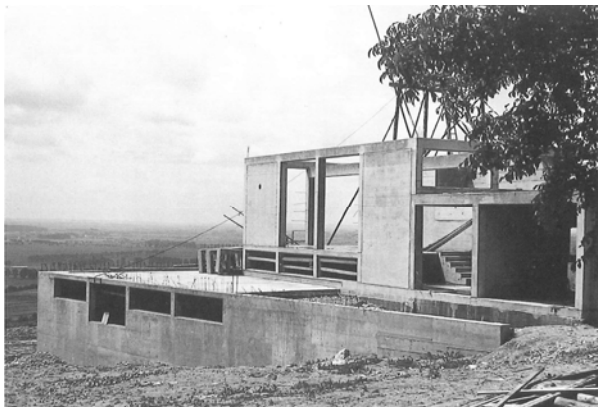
Cerramientos construidos con encofrados de tableros Pavatex. (Quijano 1998)
